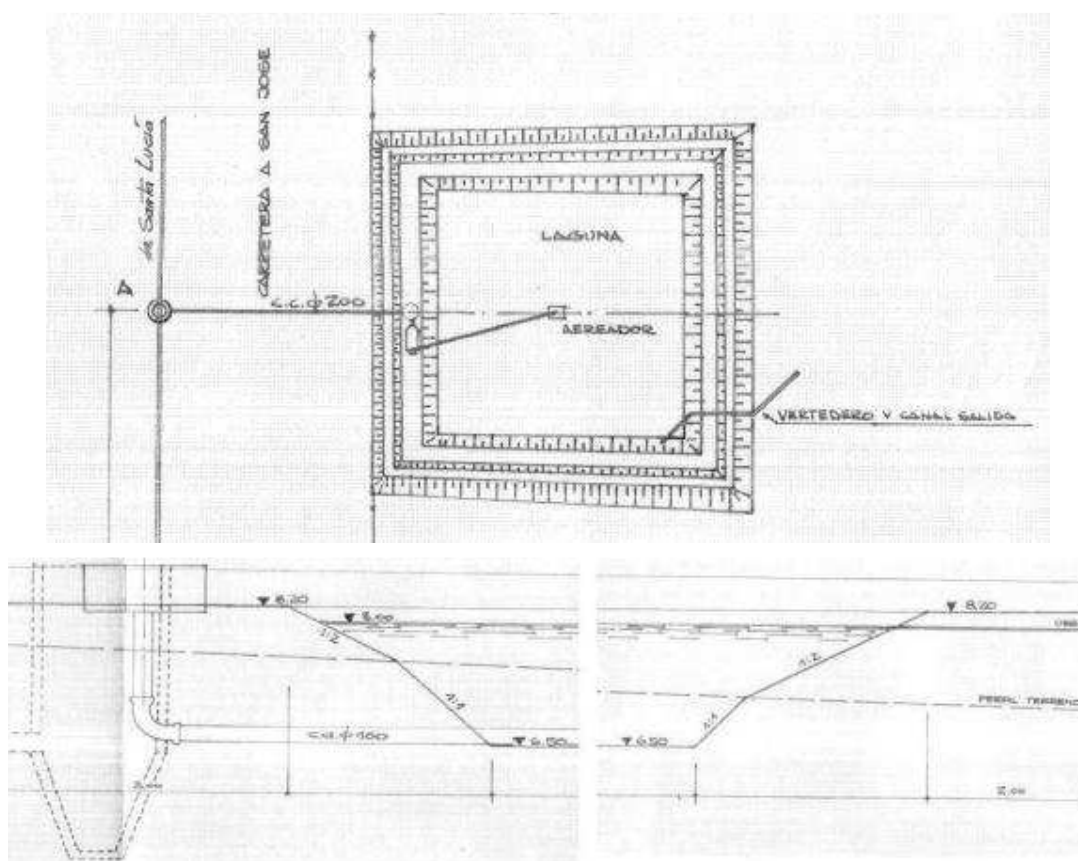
Primer sistema de tratamiento usado por Santa Lucía (Fuente: OSE, Archivo)
